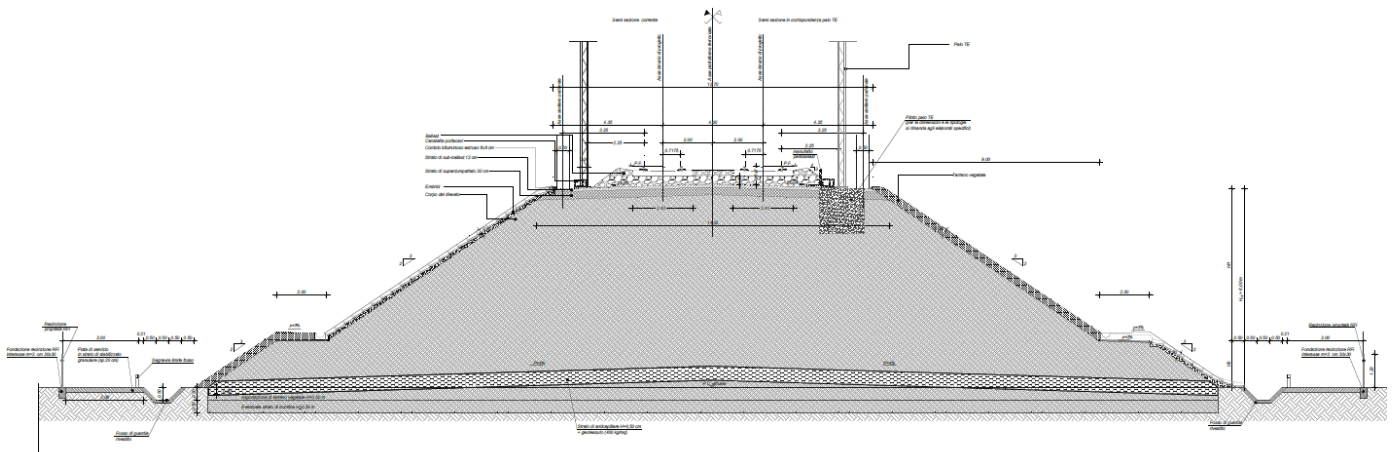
Sezione tipo ferroviaria in rilevato a doppio binario (piattaforma in retto) con $H_{ril} > 6,00$ m
